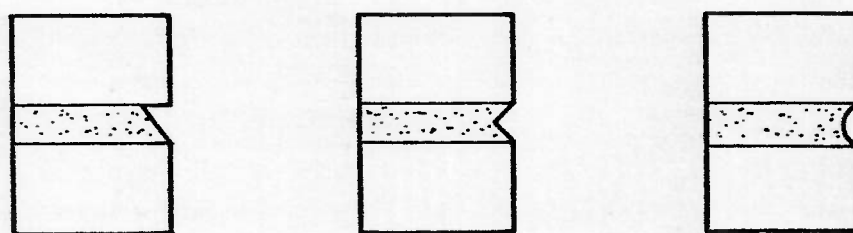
Frisamento de juntas em alvenarias aparentes de fachadas
